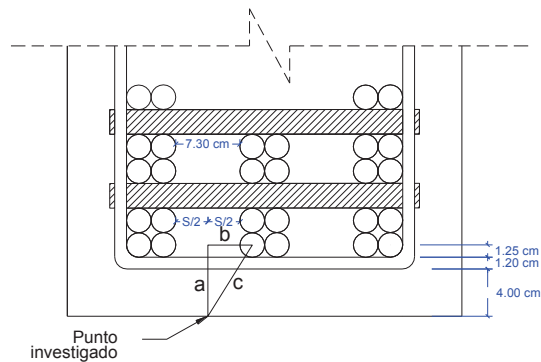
Detalle del punto crítico de posible agrietamiento en la viga interior y exterior.
